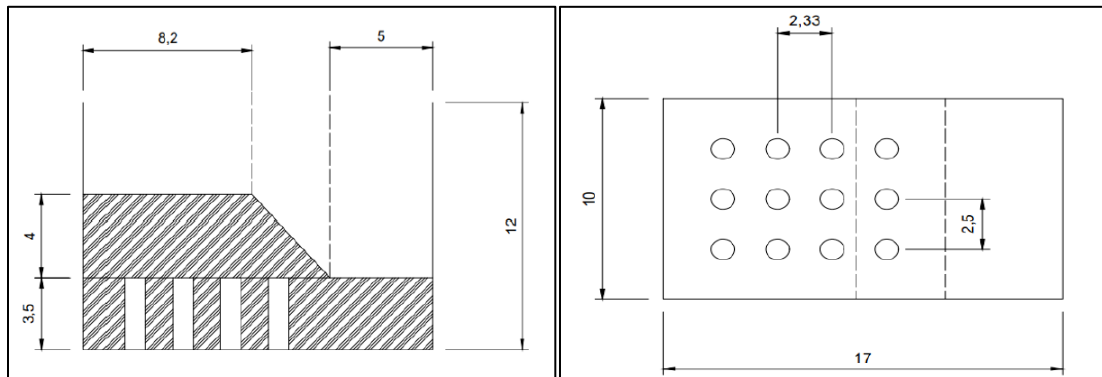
Modelo de suelo reforzado con columnas de suelo cemento. Distribución en planta de columnas bajo el terraplén.
